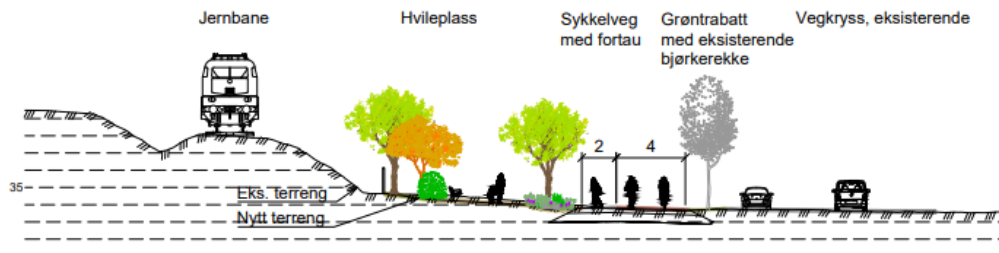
Illustrasjonsplan. Tegning O101, alternativ 4+2
